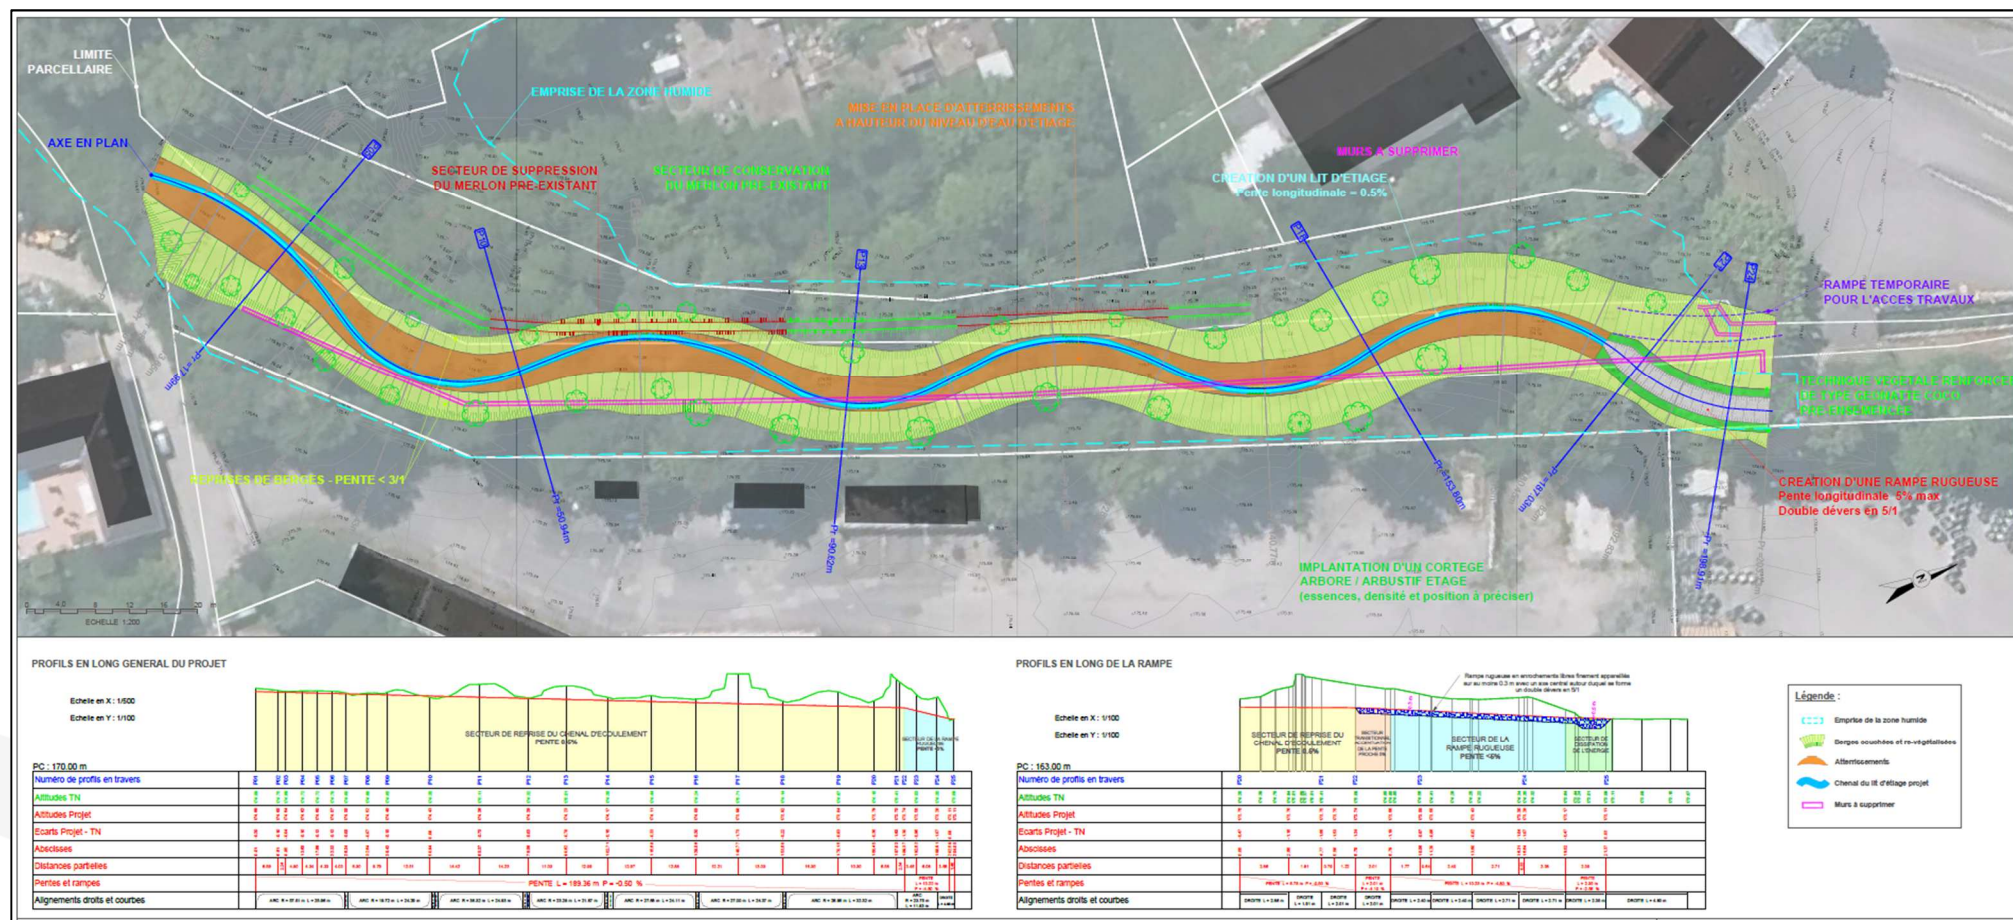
Plan et profil en long du projet de restructuration du secteur amont de la mouche (cf annexe)
